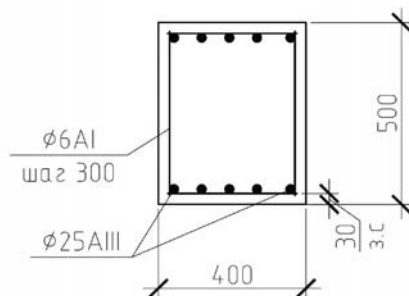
Схема расположения рабочей арматуры в железобетонных опорах сечением 400х500 мм
